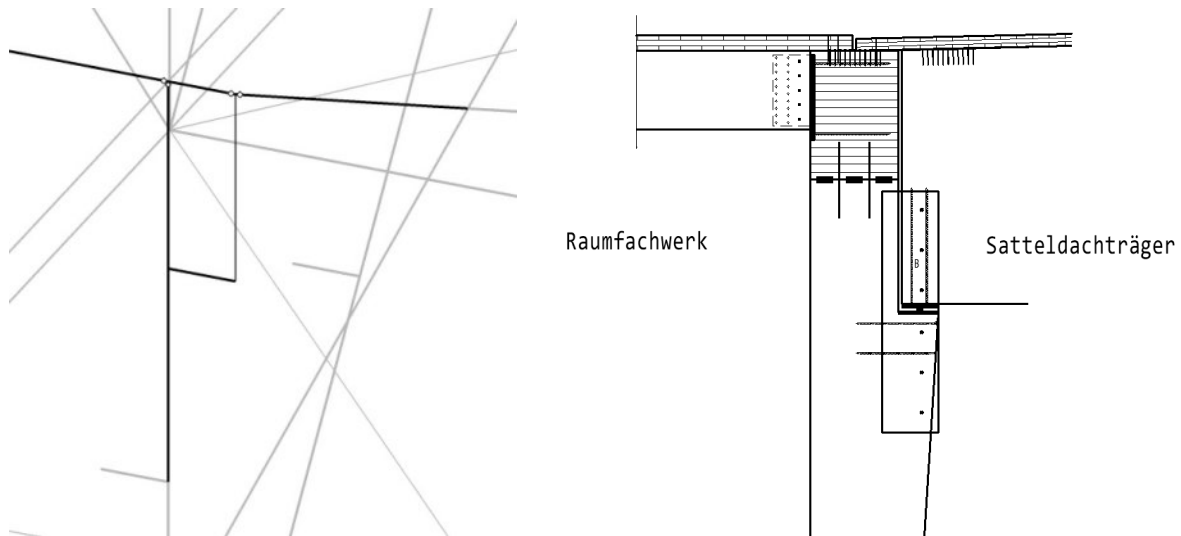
Modell B – Modellierung Anschluss Satteldachträger – Fachwerk. Vergleich Modellbildung Ausführung.
